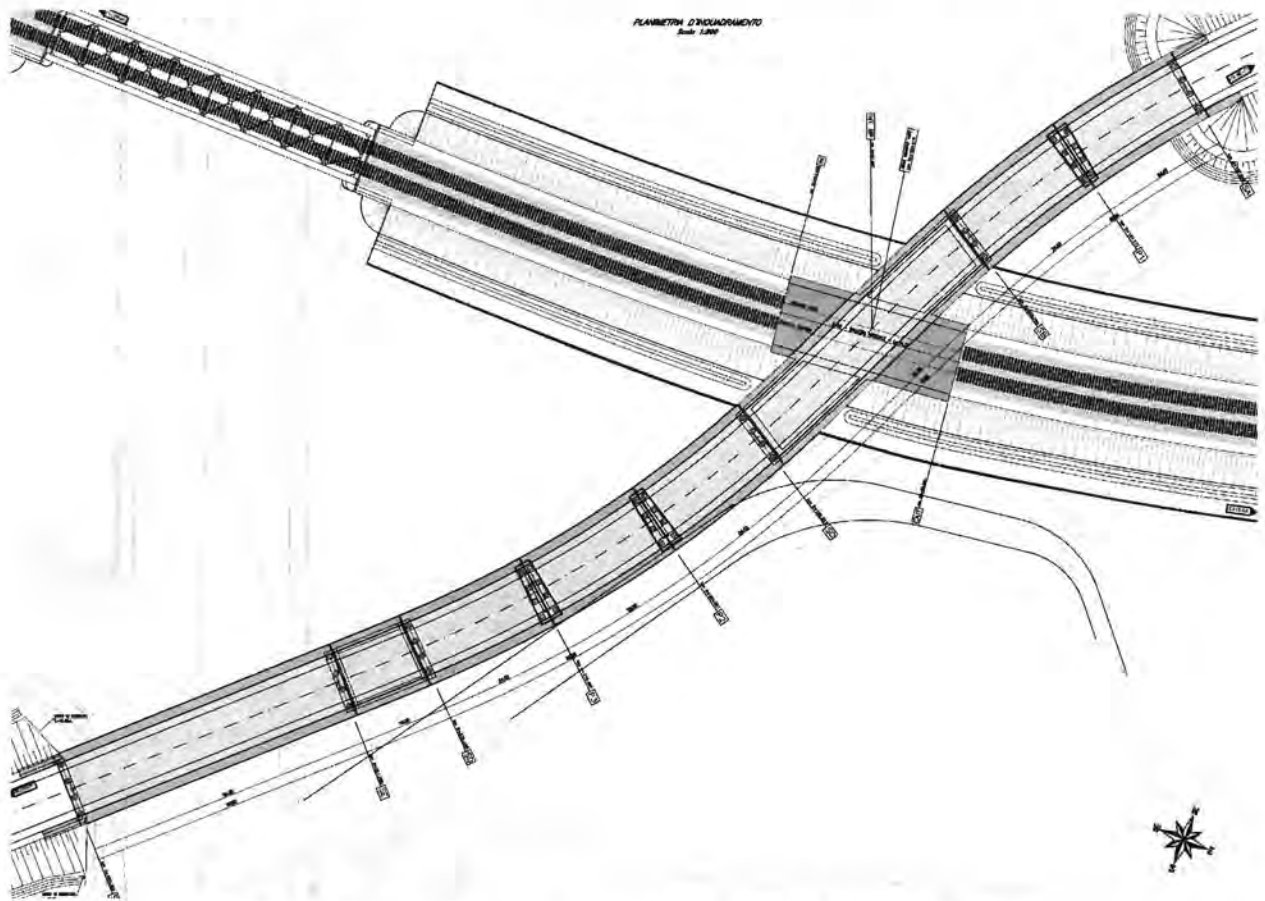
Planimetria sottopasso scatolare e relativo cavalcavia
